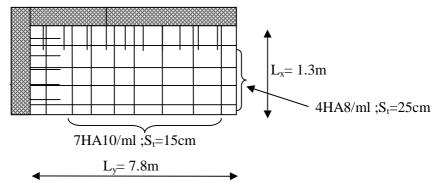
schéma de ferraillage de la dalle sur deux appuis.
